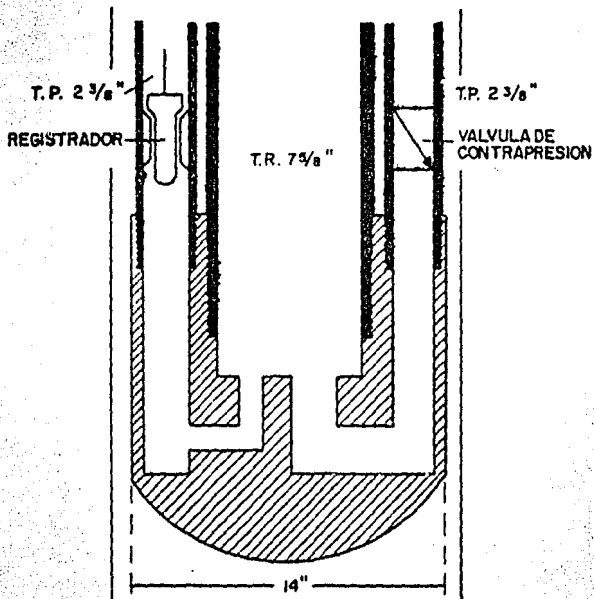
A DETALLE DE LA ZAPATA DE UNION
